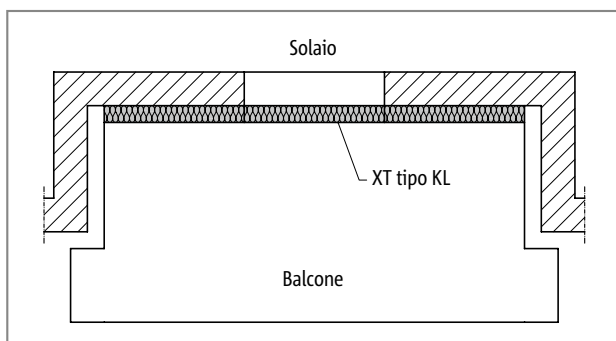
Schöck Isokorb® XT tipo KL: balcone con elementi rientranti nella facciata
